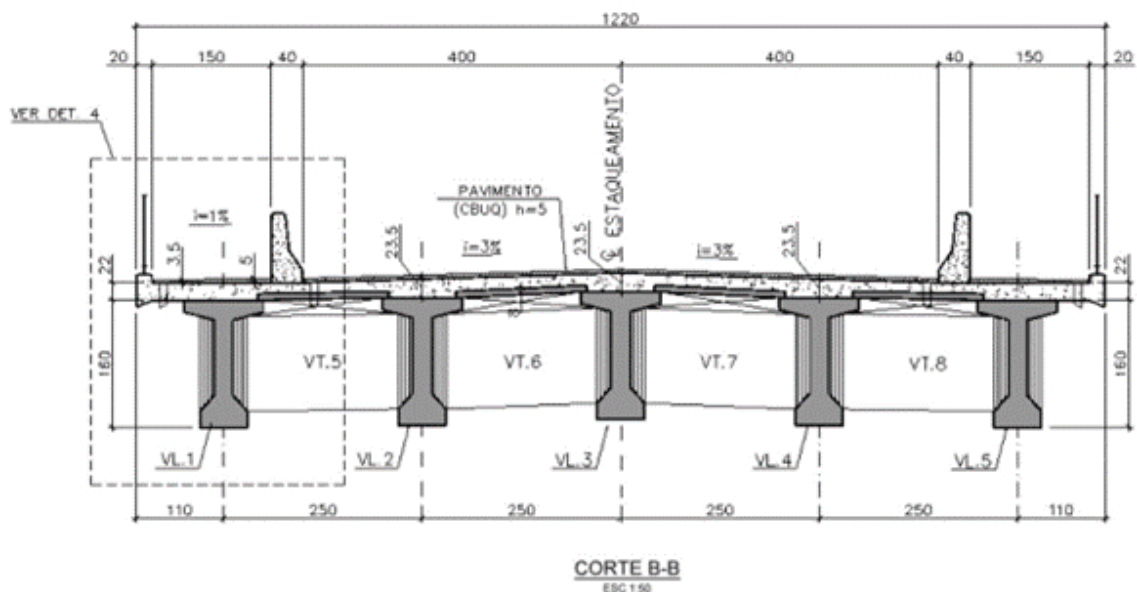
Seção típica da ponte do Complexo Viário.
